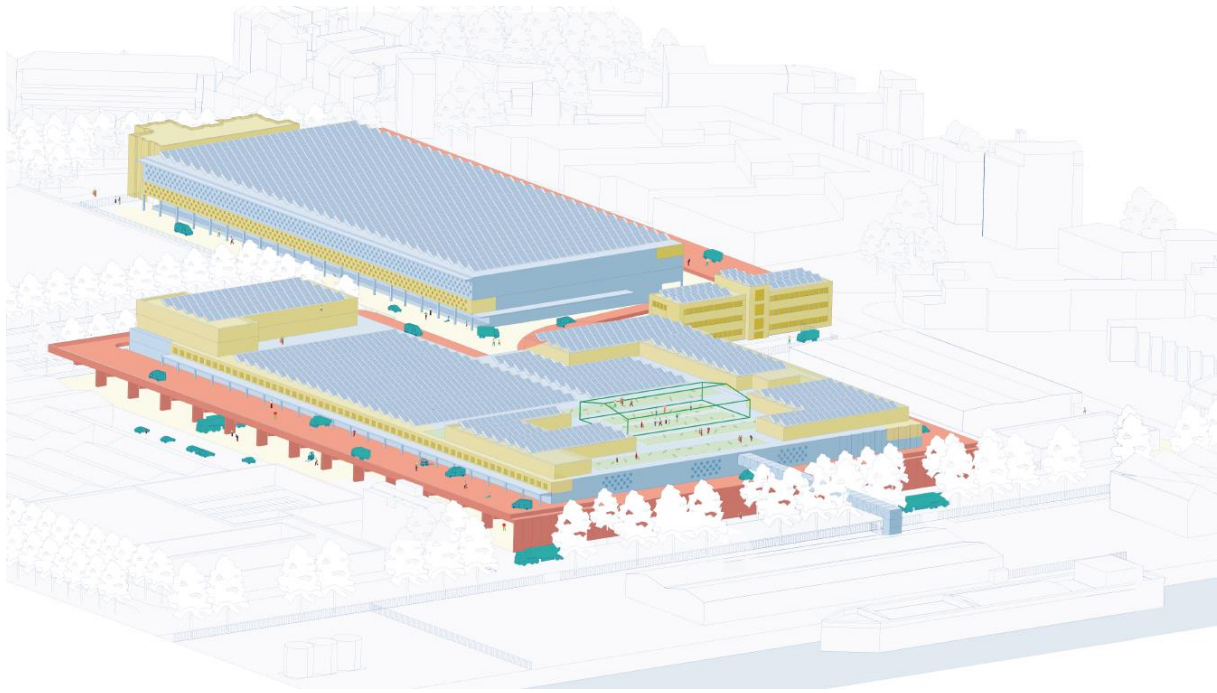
scénario 1 - Rénovation poussée de l'actuel centre TIR avec, au rez-de-chaussée, une hauteur libre utile de six mètres
